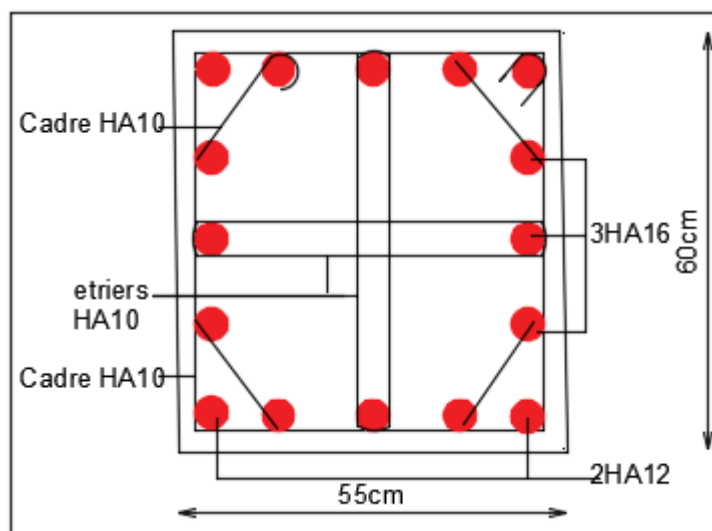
Schéma de ferrailage des poteaux 1^{er} étage et 2^{ème} étage
